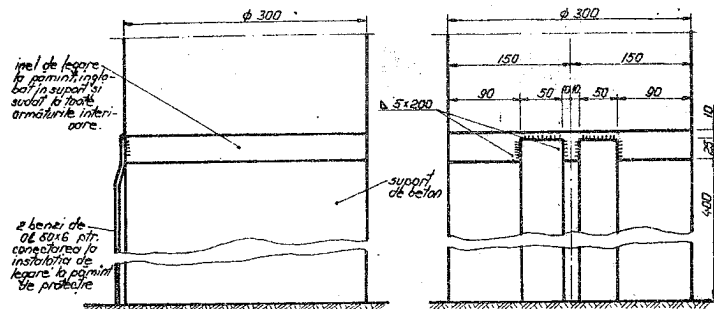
Detaliu de legare la pământ a suportilor de beton pentru susținerea aparatelor.
